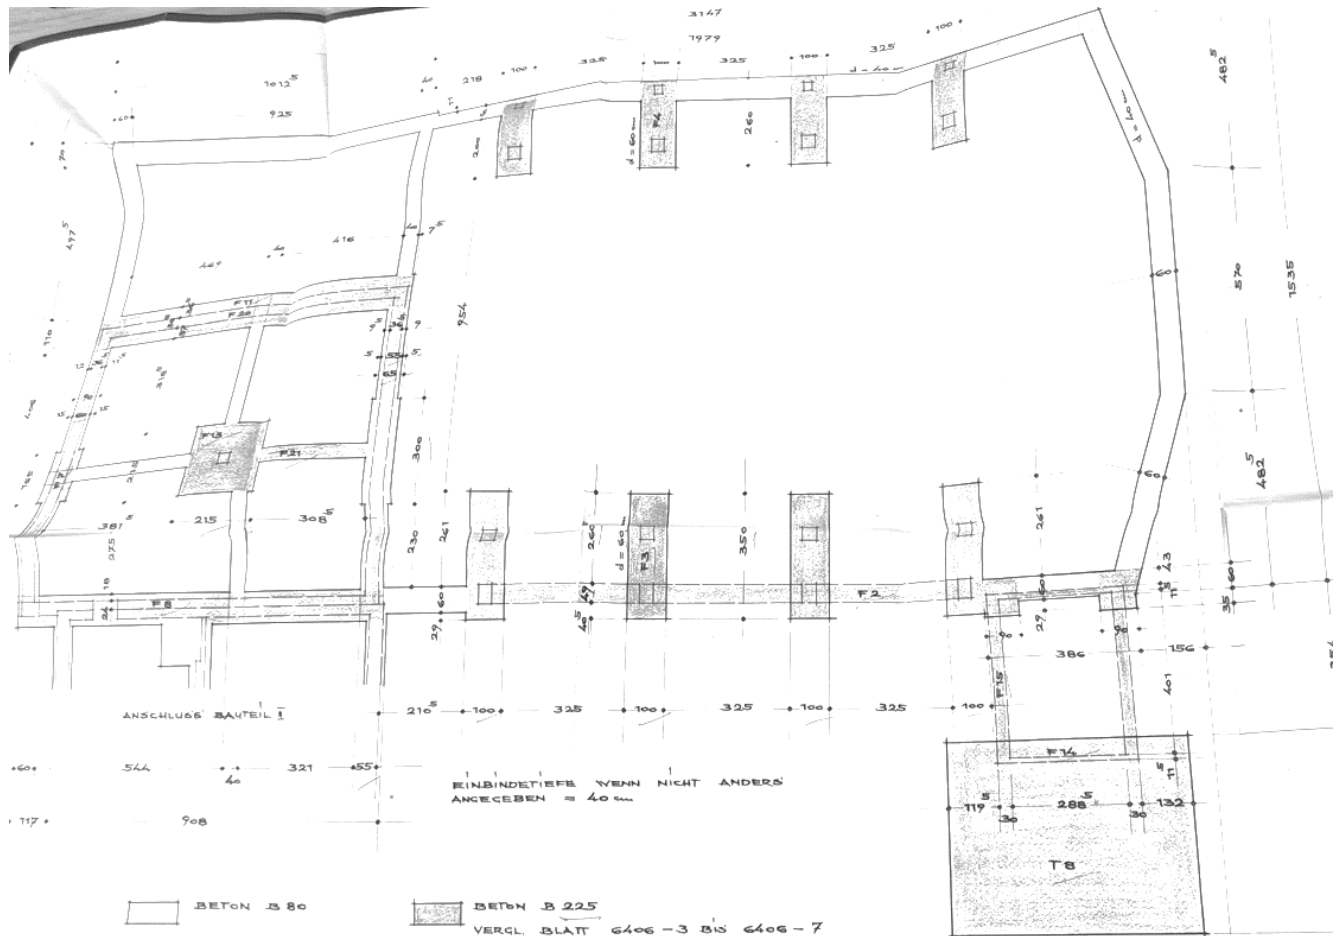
Auszug Bestandsplan [U 2] - Fundamentplan
